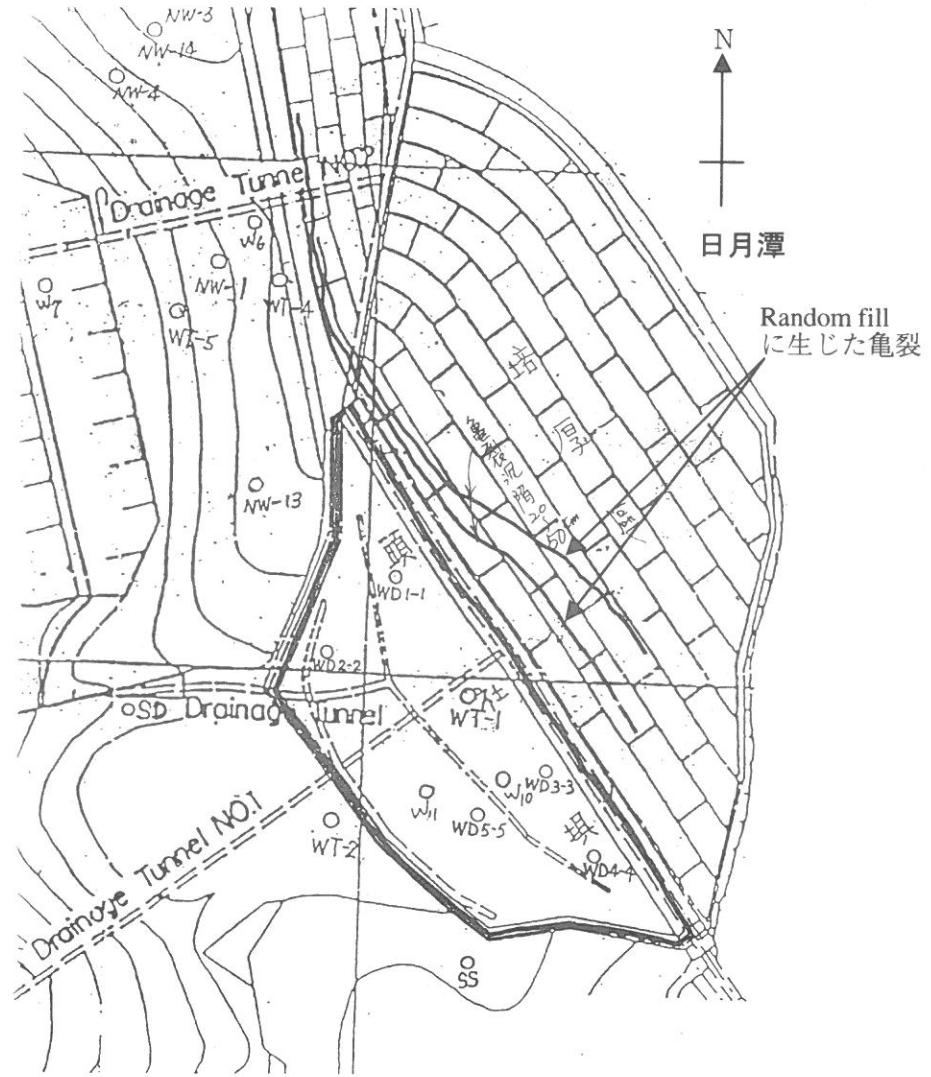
頭社ダム平面図上の亀裂の位置
